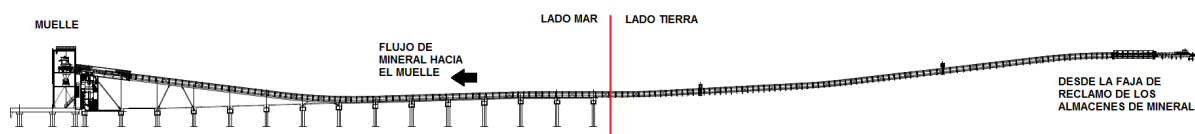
Vista lateral de la faja tubular que lleva el mineral al muelle
